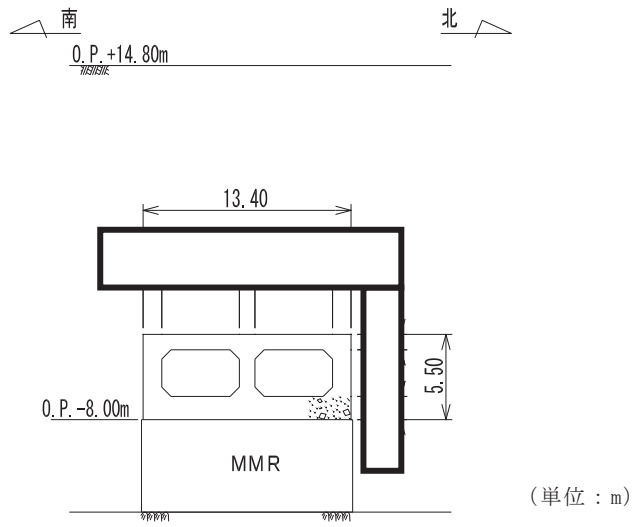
取水路（標準部）断面図（A-A 断面）
